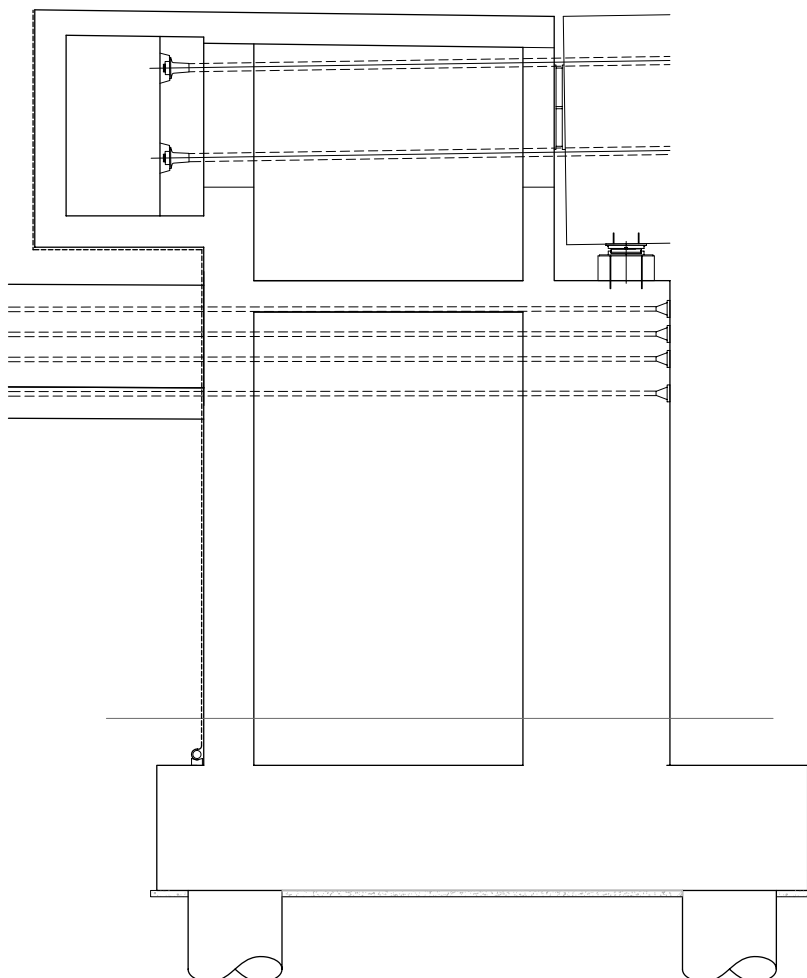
Parque de fabricación de puente empujado. Detalle de anclaje entre parque y estribo
